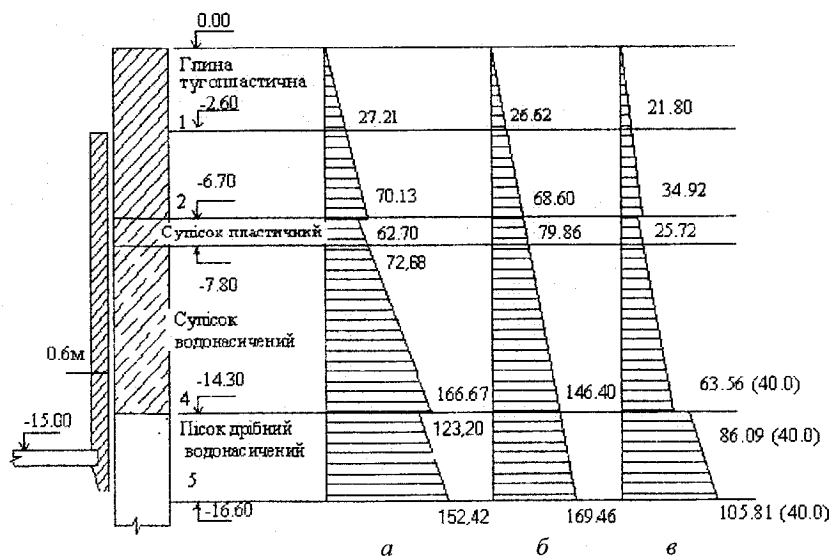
Епюри: а – горизонтального тиску і води на бокову поверхню колодязя; б – зведена епюра горизонтального тиску ґрунту; в – сил тертя на бічній поверхні колодязя
